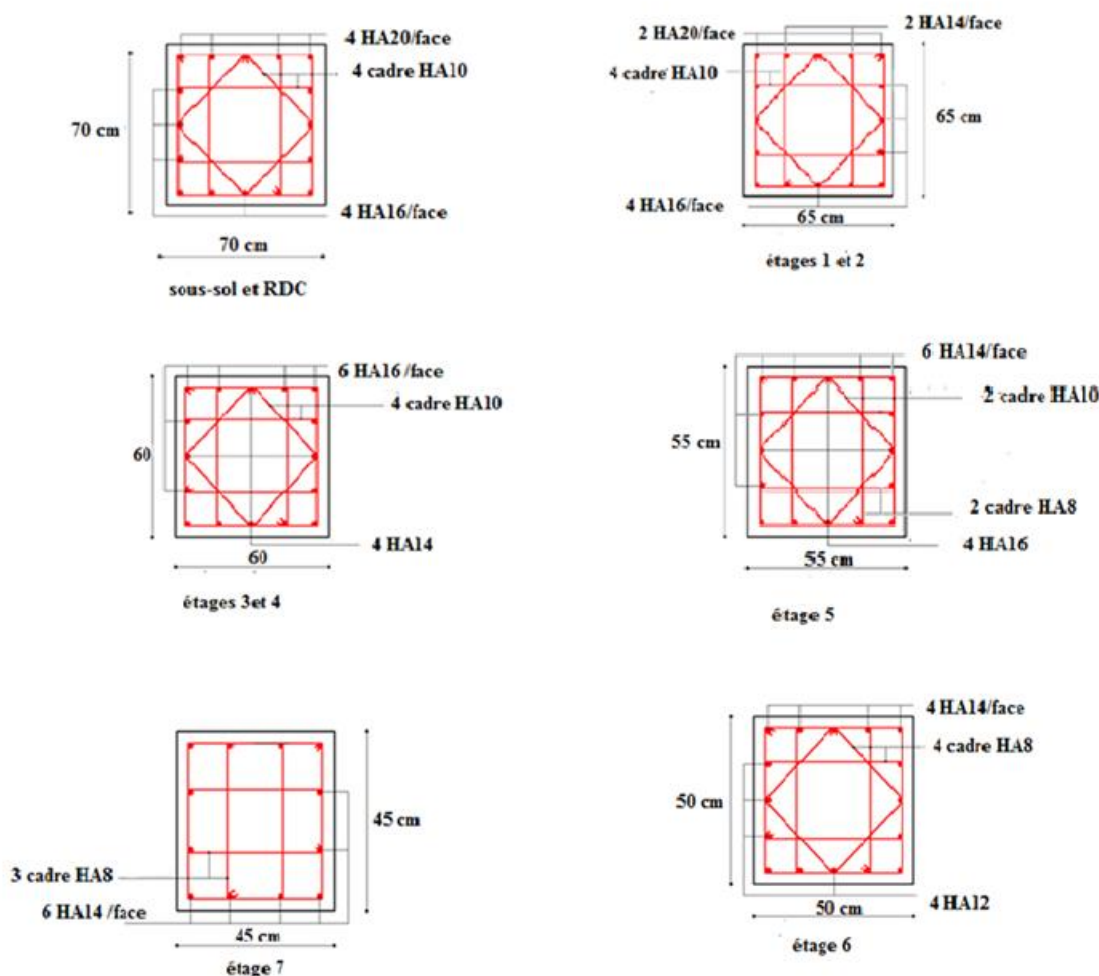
Schéma de ferrailage des poteaux rectangulaires
